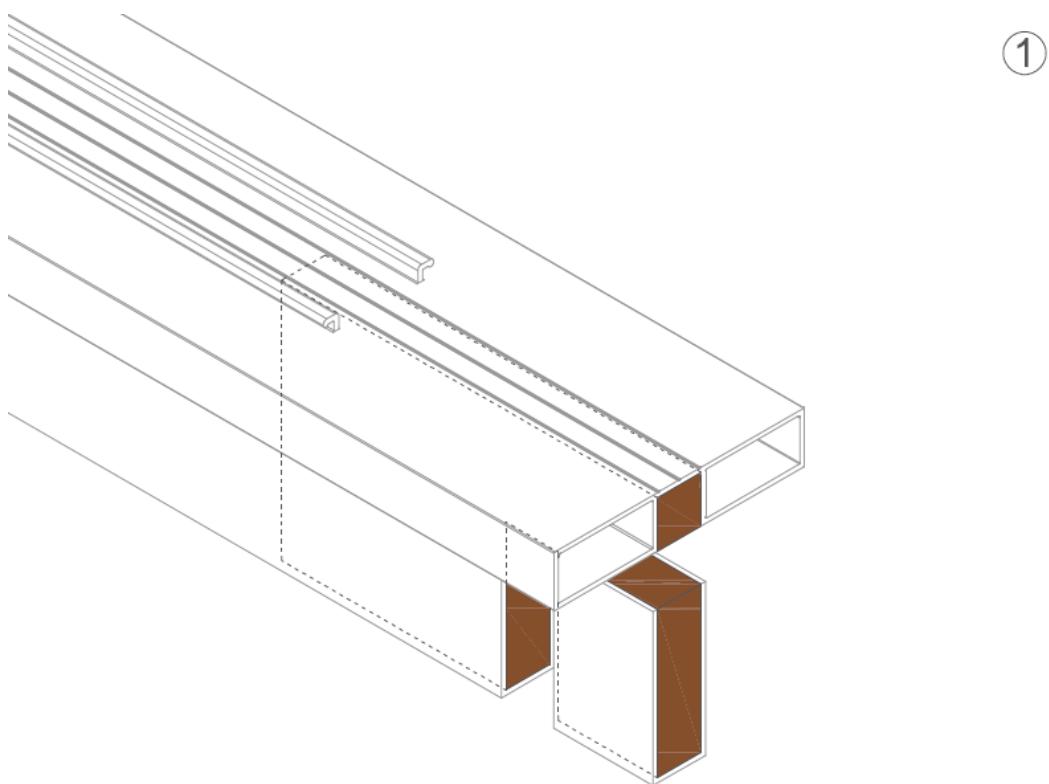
Solução Final – Pormenor do reforço em madeira no perfil transversal.
